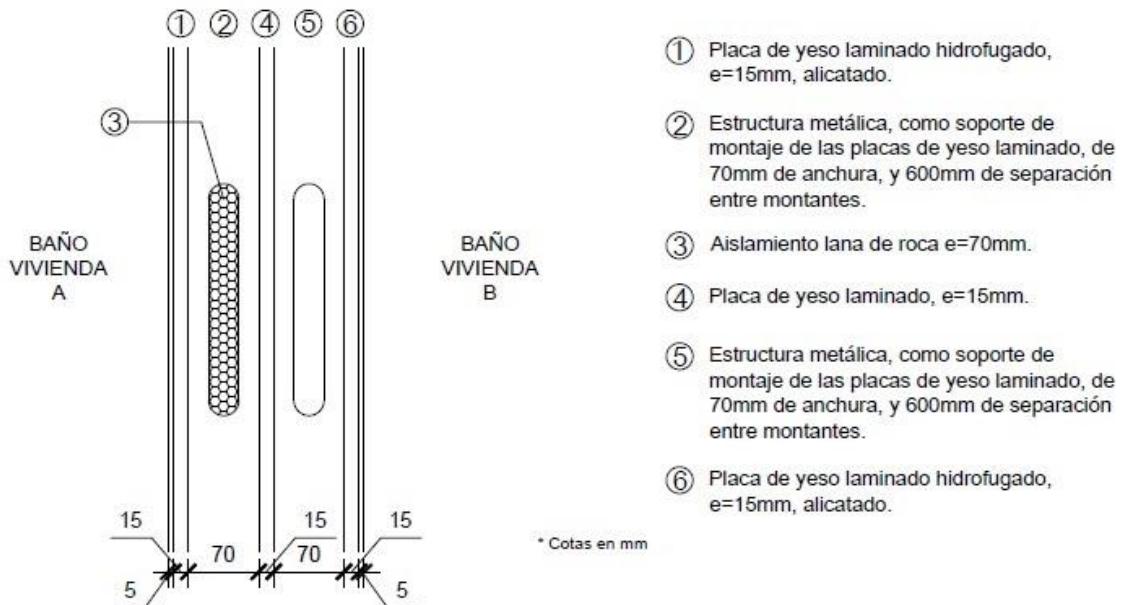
Cerramiento de medianería tipo "Baño vivienda A-Baño vivienda B"
